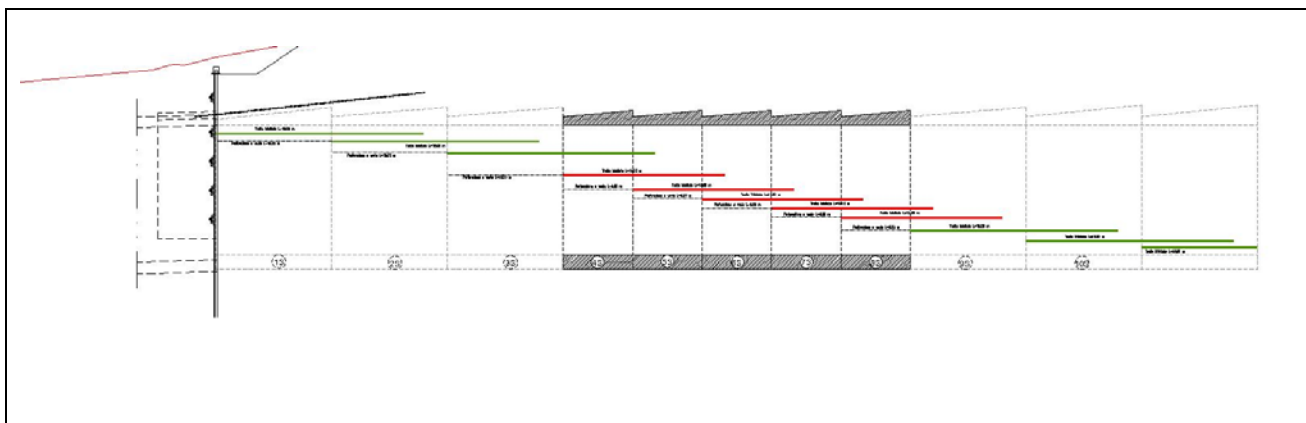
Sezione di scavo tipo GD-C2 – Schema delle fasi di consolidamento del fronte in corrispondenza degli edifici 12 e 14.
